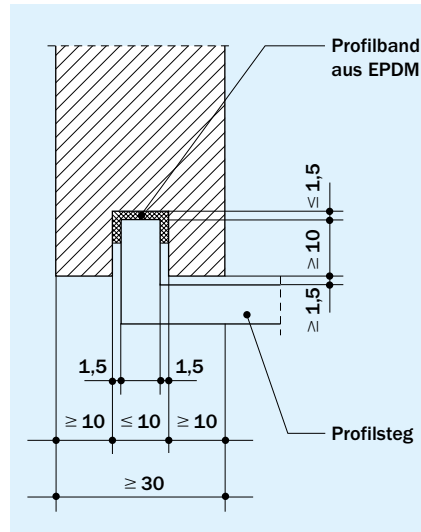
Nicht sichtbare Befestigung mit Profilstegen
